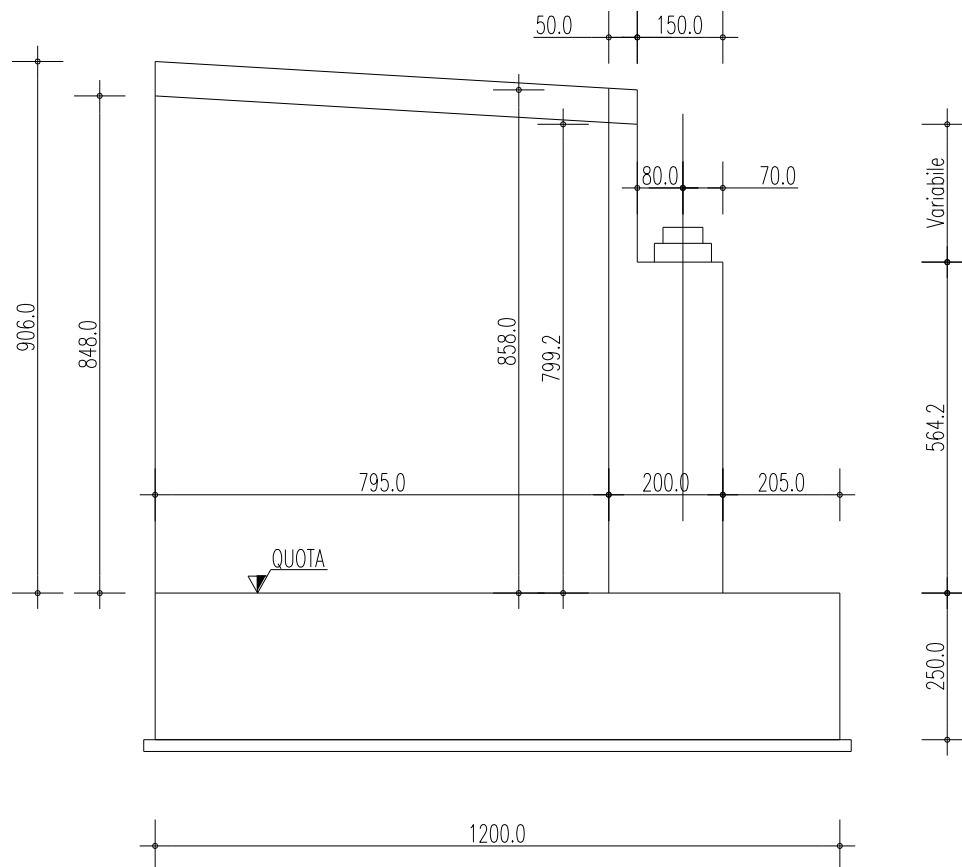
Vista laterale Spalla A-r.
